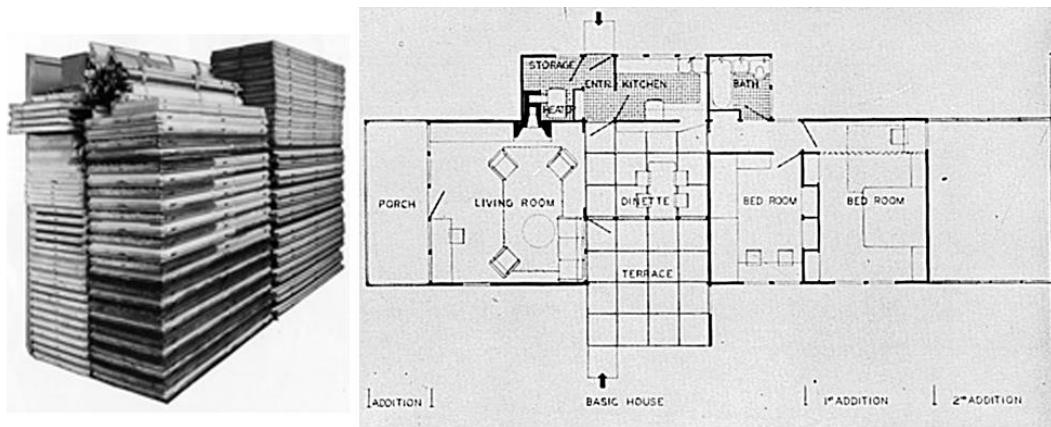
Packaged House (1941), elementos de montagem e planta tipo.
